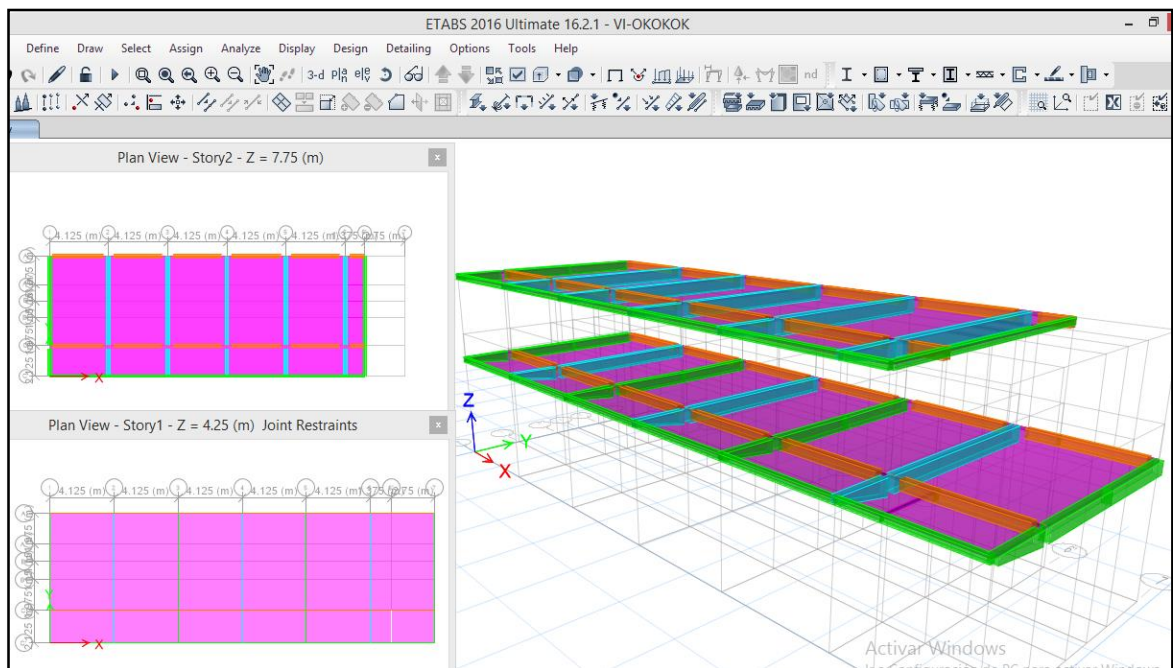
Dibujo de todas las vigas y losas aligeradas del sistema estructural del módulo VI.
